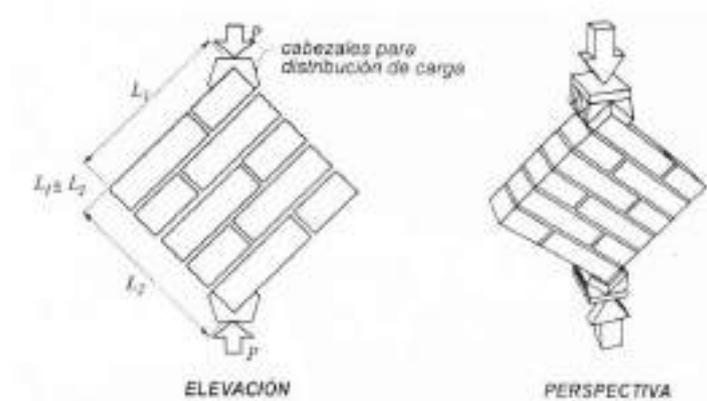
Esquema del ensayo a compresión diagonal de muretes de bloques de concreto
